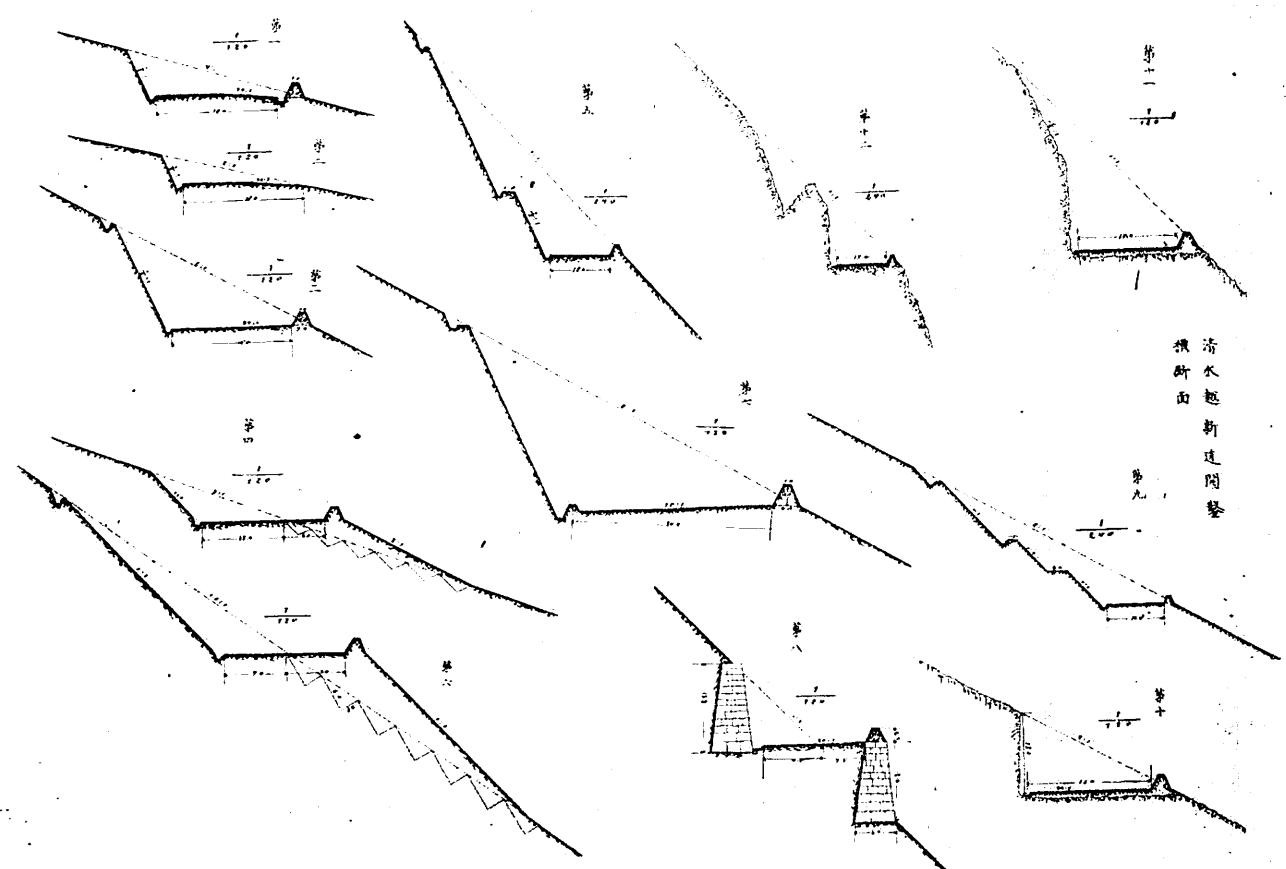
清水越新道開鑿図 (横断面図) ⁸⁾
